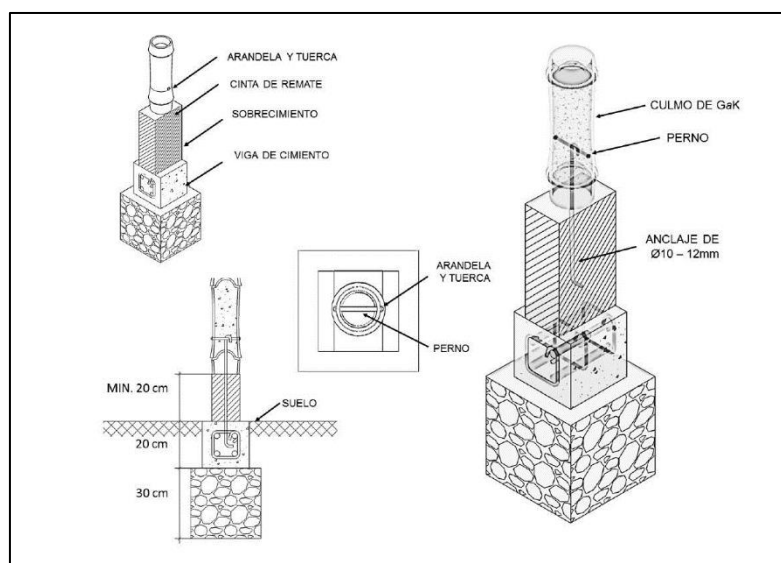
Detalle de apoyo de columnas en sobrecimiento Fuente: (NEC-SE-GUADUA, 2016)
